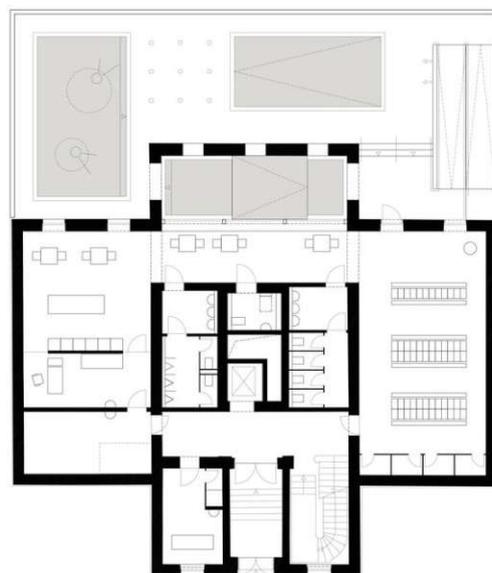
, Grundriss Volksbad Mondscheingasse, 1887
